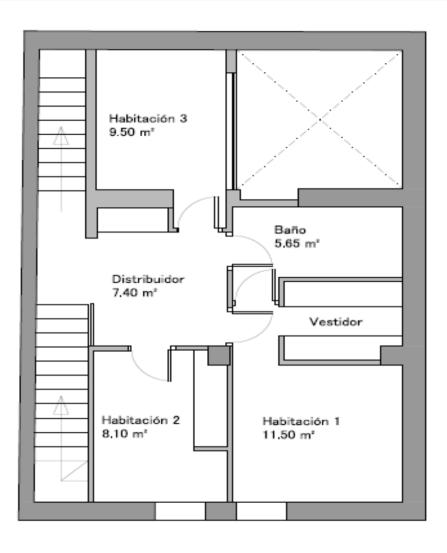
Plano primera planta actual. Fuente: Elaboración propia.
